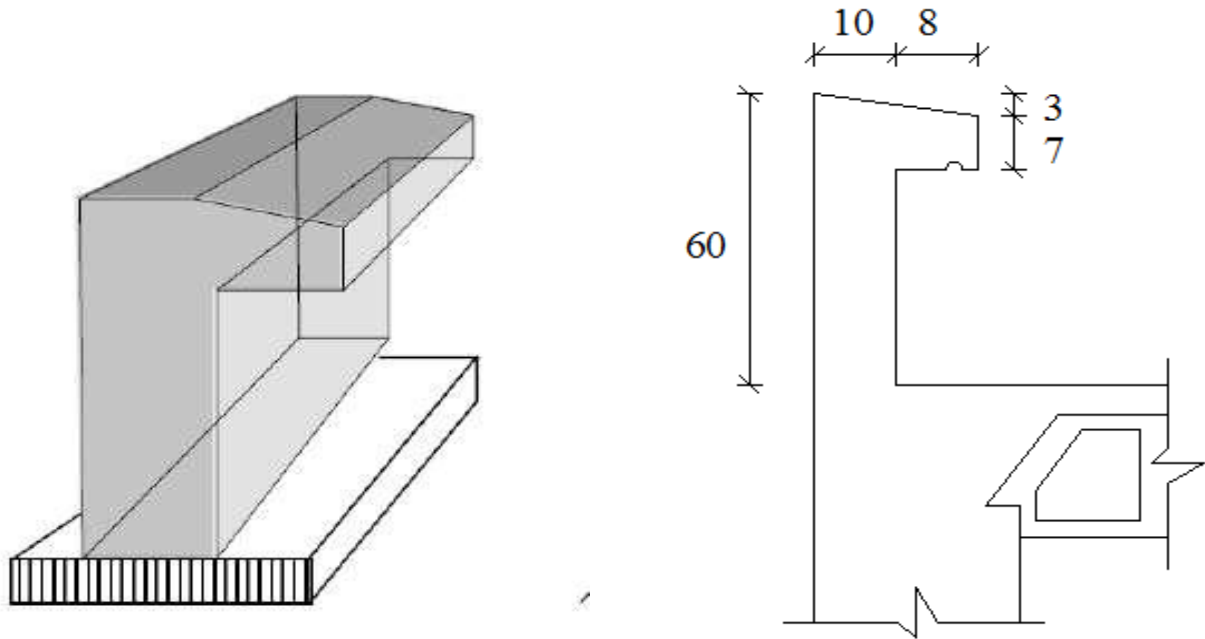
Les dimensions de l'acrotère et schéma statique
